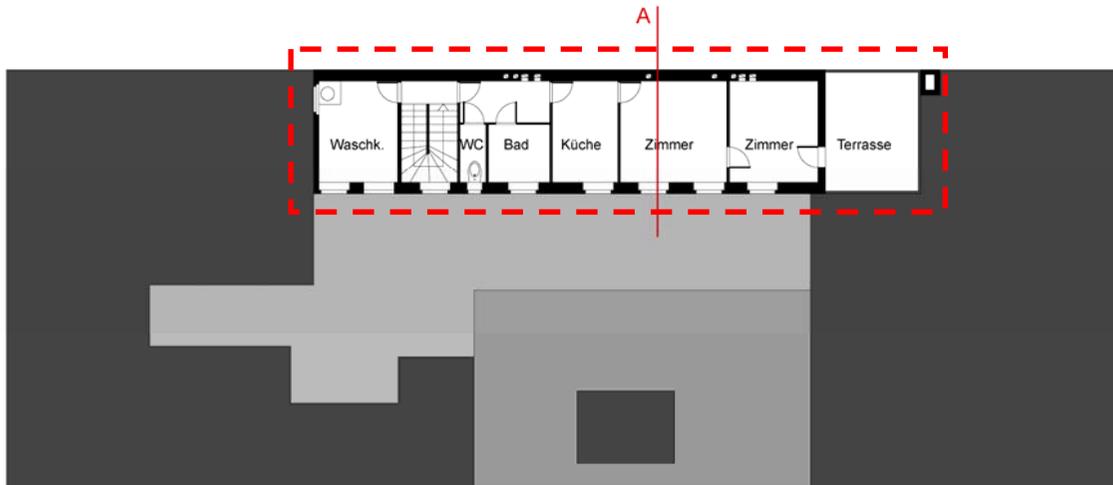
Grundriss zweites Obergeschoss, Privatwohnung Krenn jun.
